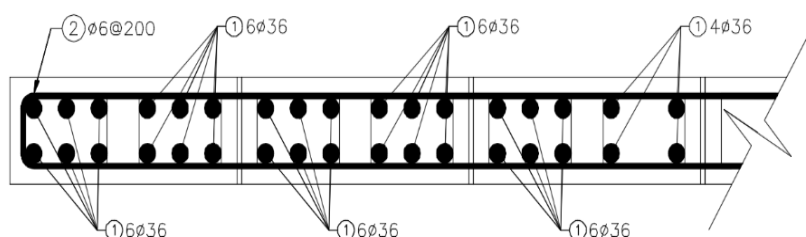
Distribución del refuerzo del tímpano de mampostería.
